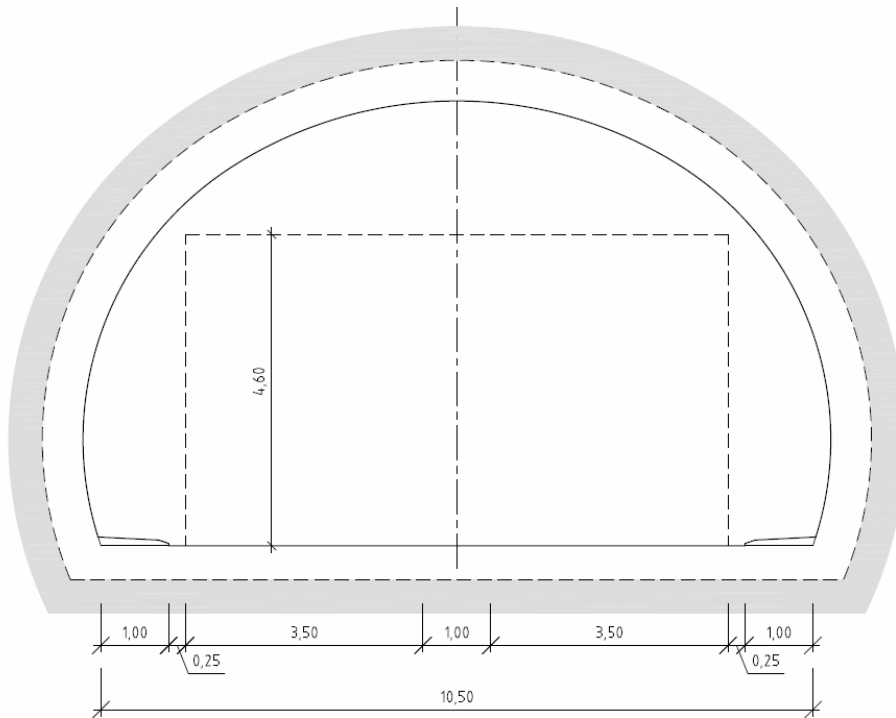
Tunnelprofil T9,5 (mål i m)
